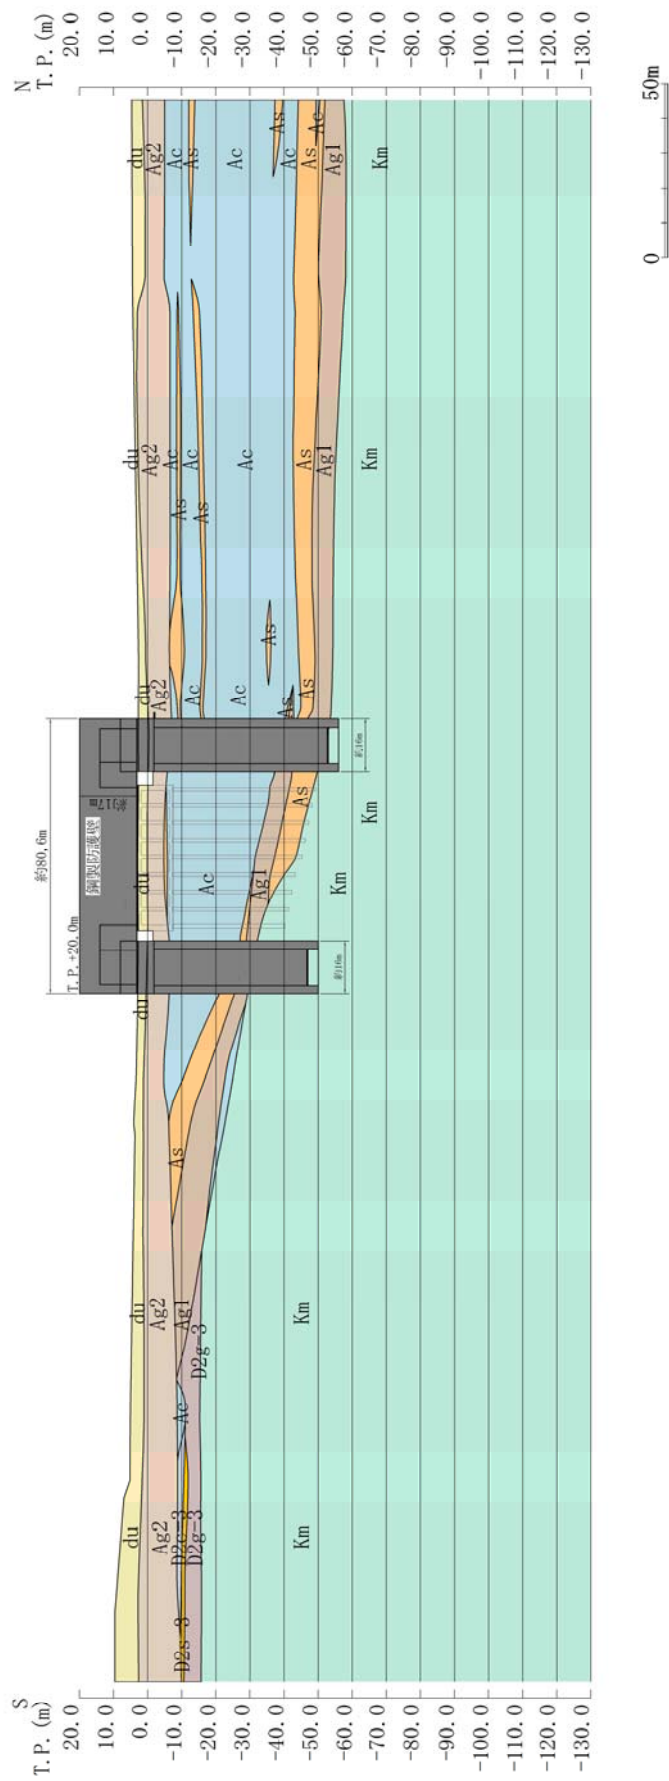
(1) 鋼製防護壁断面图 (①—①断面)
